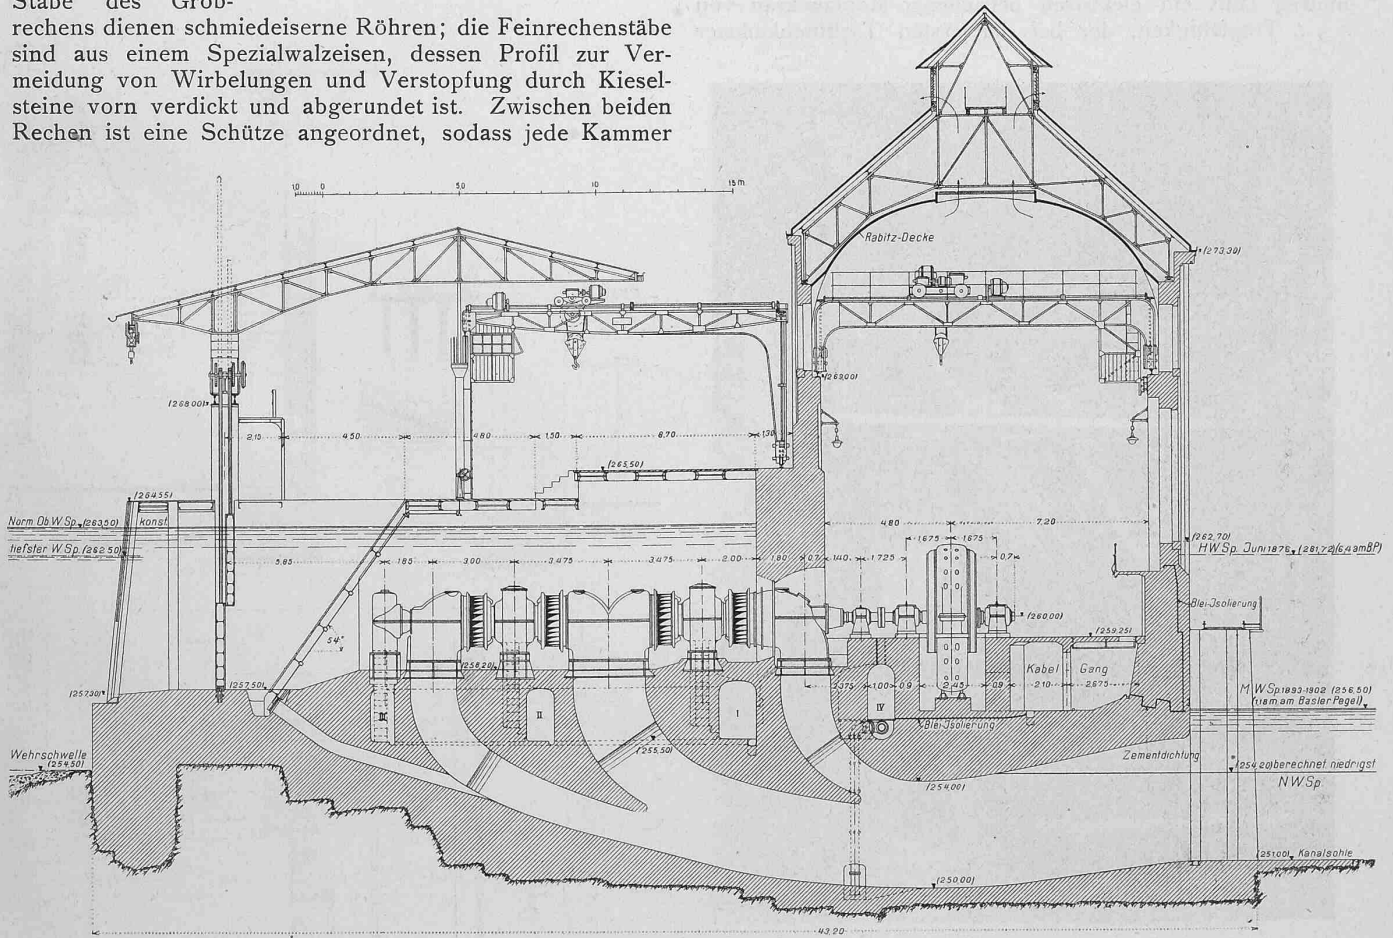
Querschnitt des Generatoreng Gebäudes mit den Turbinenkammern. — Masstab 1 : 250.
